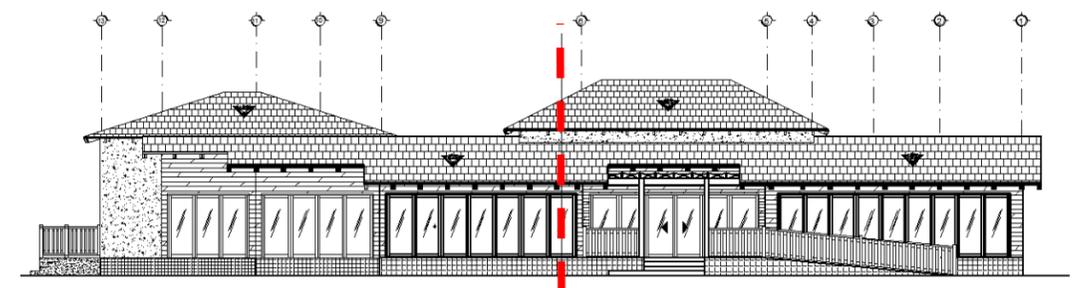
Simetría en fachada de administración. Fuente: Elaborado por autores
